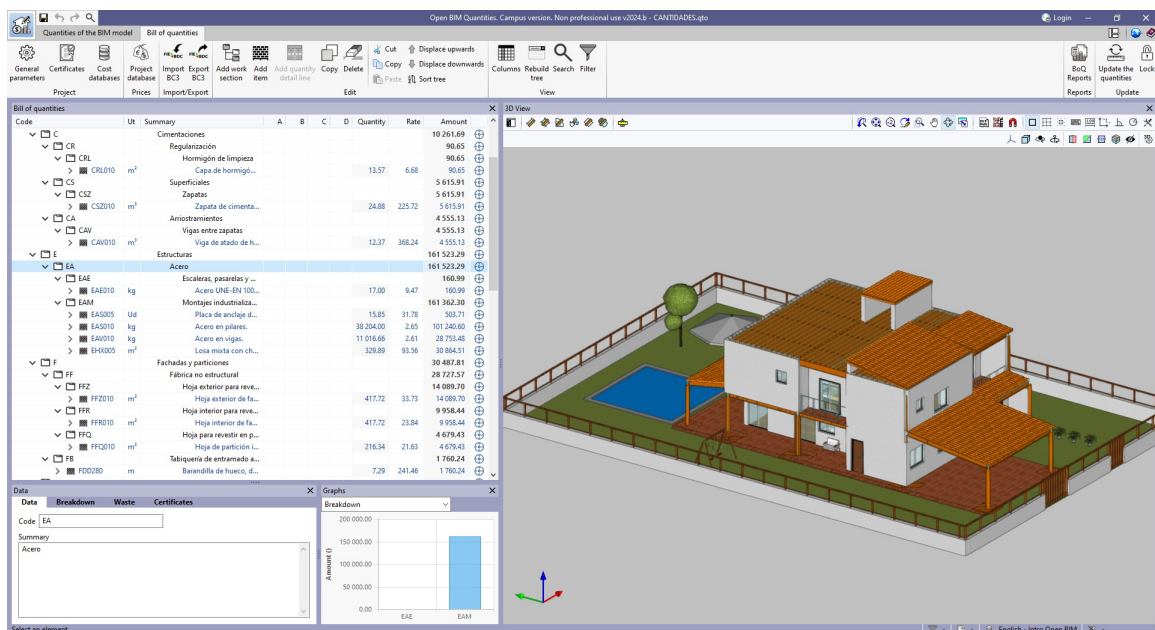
Elementos arquitectónicos de la casa con estructura de acero de Cype Architecture
